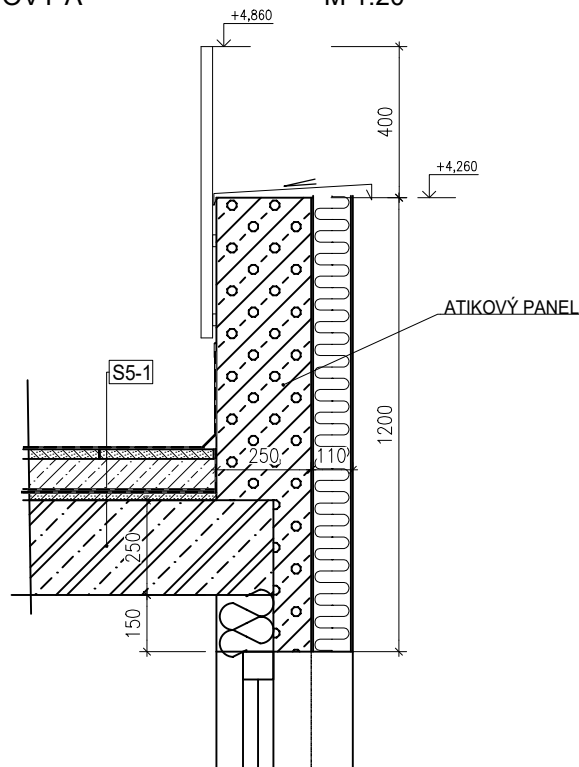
DETAIL ATIKY PRO HLAVNÍ STŘECHY
